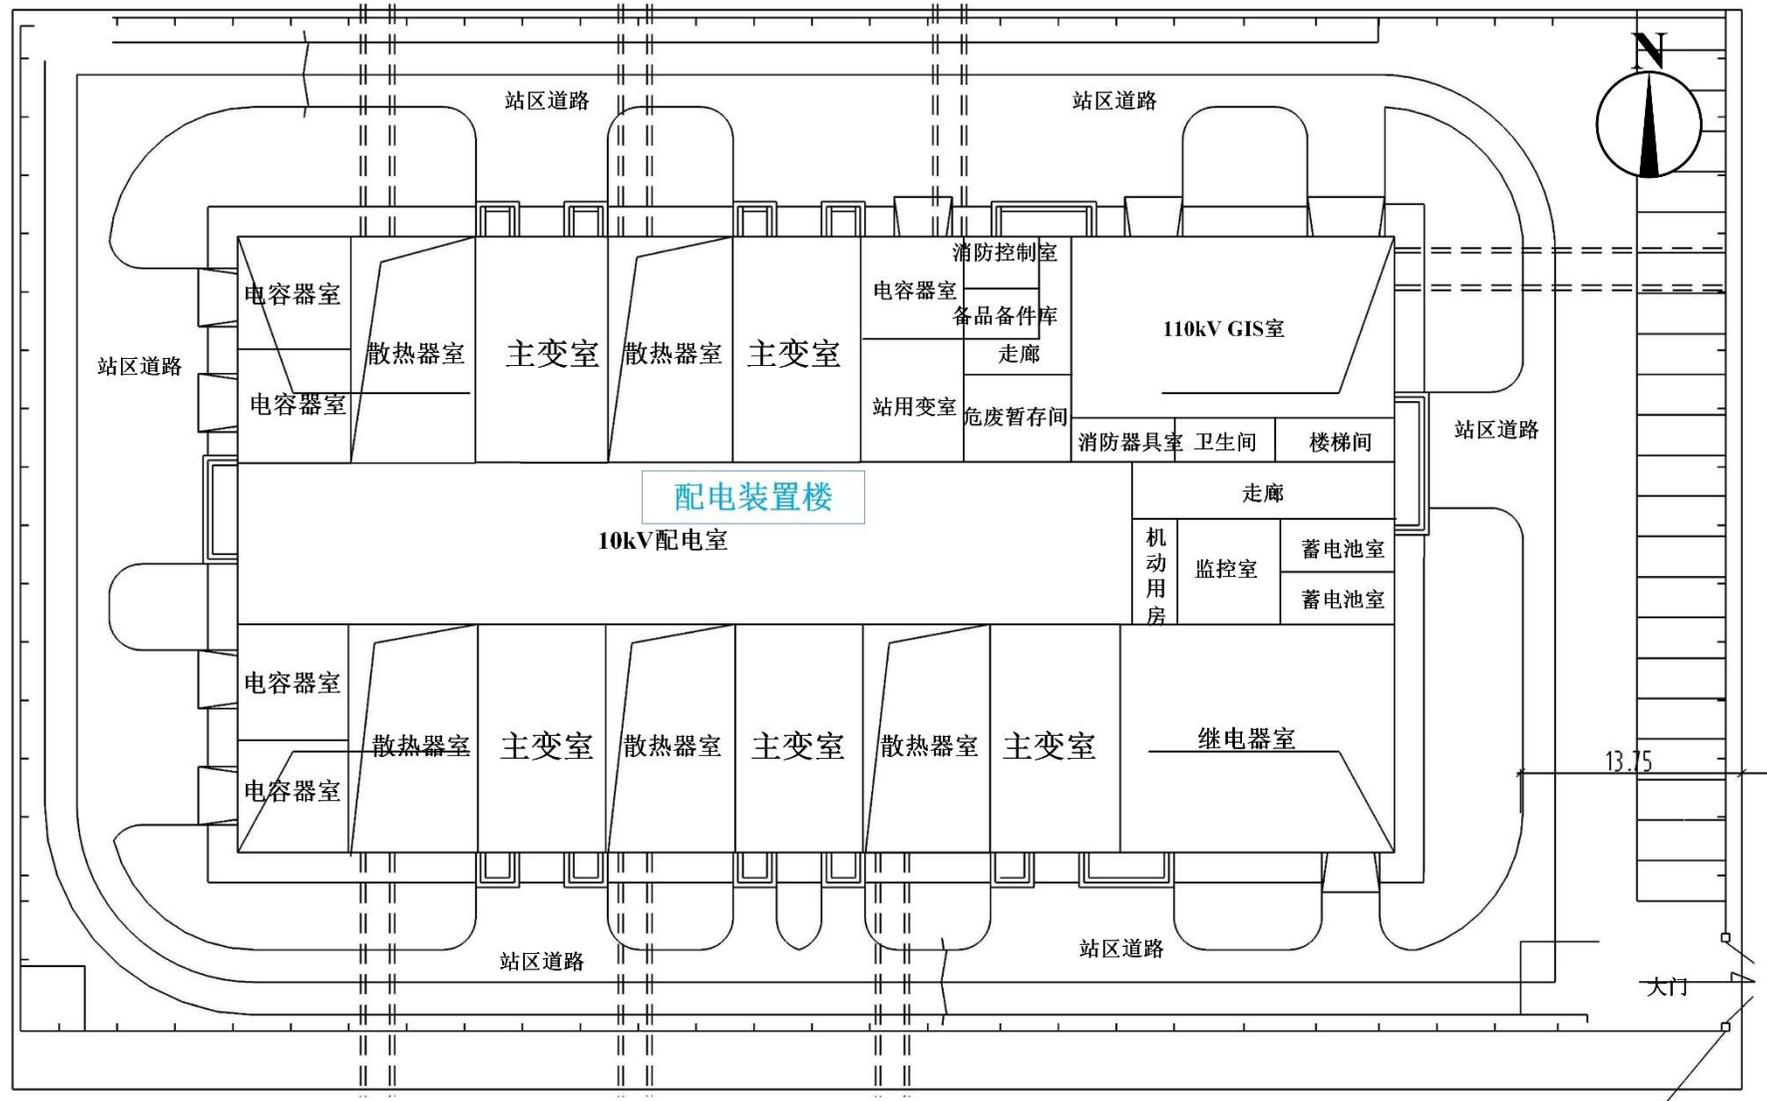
隆基 3#110kV 变电站总平面布置示意图及变电站配电装置楼示意图
